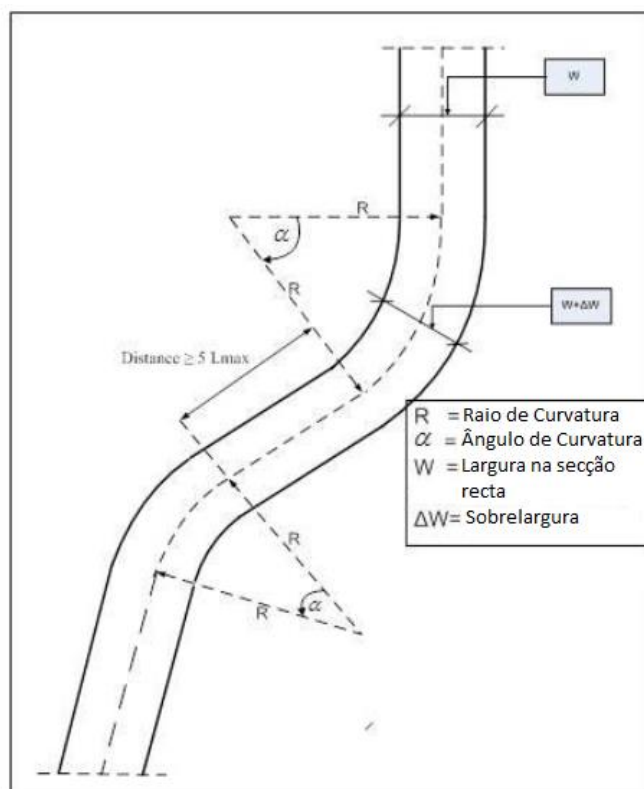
Planta do canal de aproximação – Fonte: Adaptado PIANC, 2014
